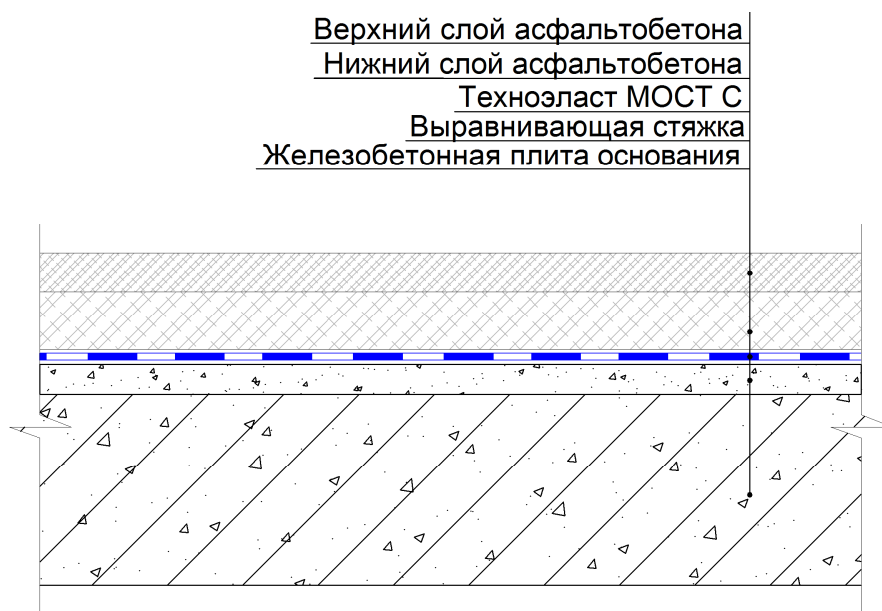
Конструкция дорожной одежды на железобетонной плите.
